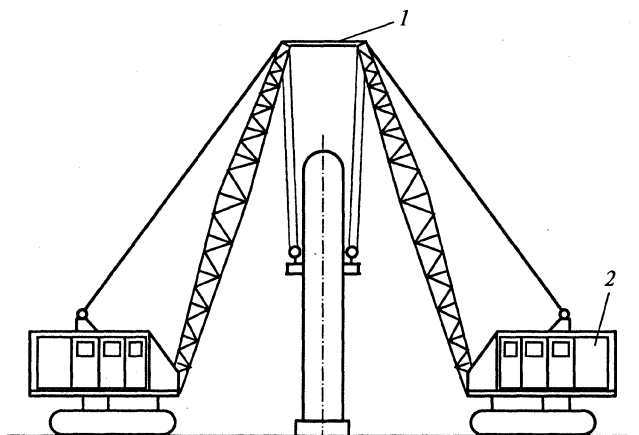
Схема кранов со стрелами, соединенными ригелем:
